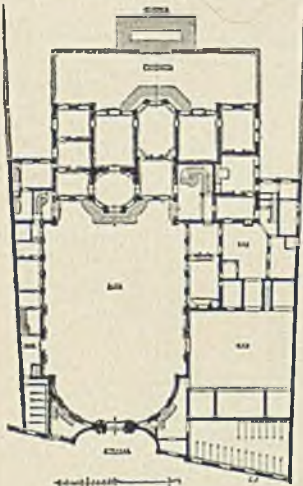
Grundriß des Hôtels de Maignon zu Paris
